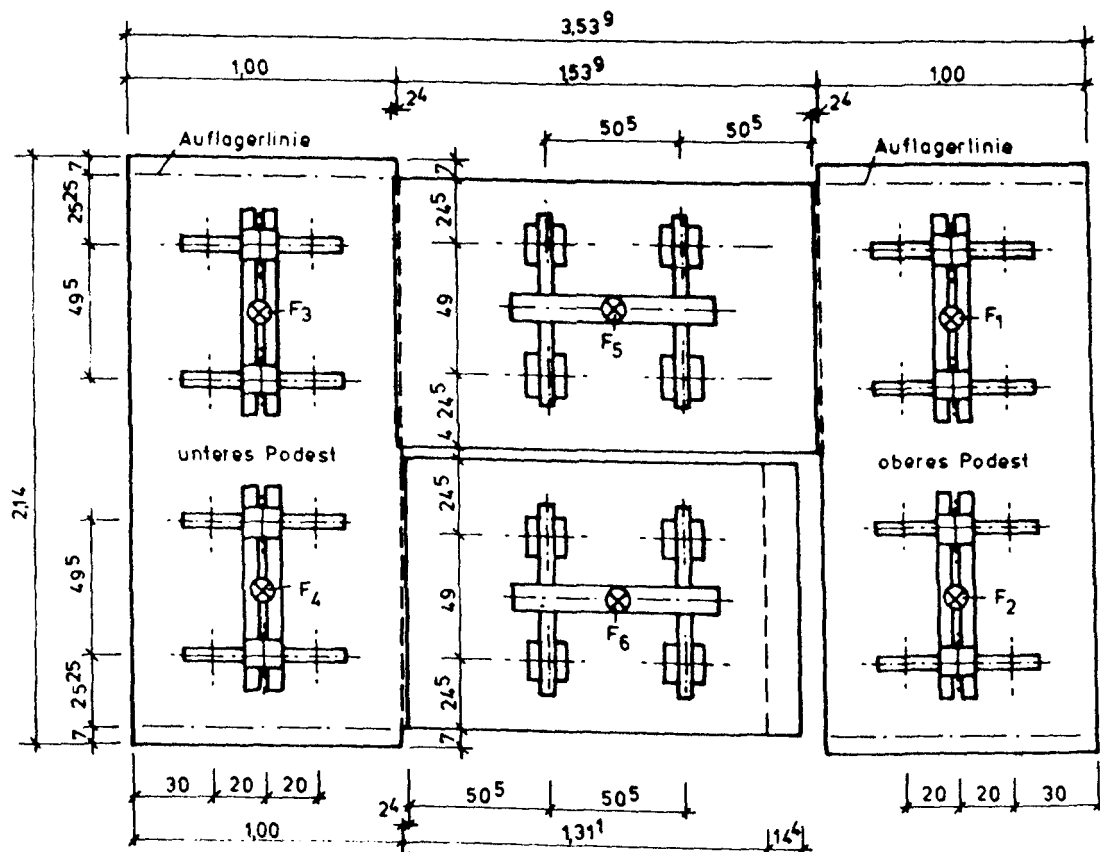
Grundriß des Versuchskörpers und Anordnung der Verteilungsträger für die Last
